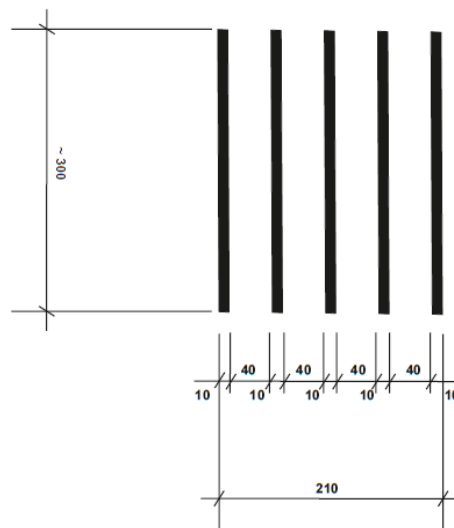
Detailausführung eines Markierungsblocks mit Maßen
